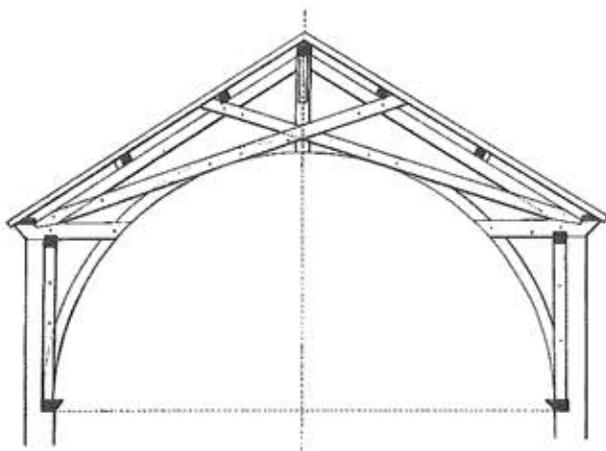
g – Sistema strutturale con irrigidimenti finalizzati alla riduzione delle spinte laterali.
